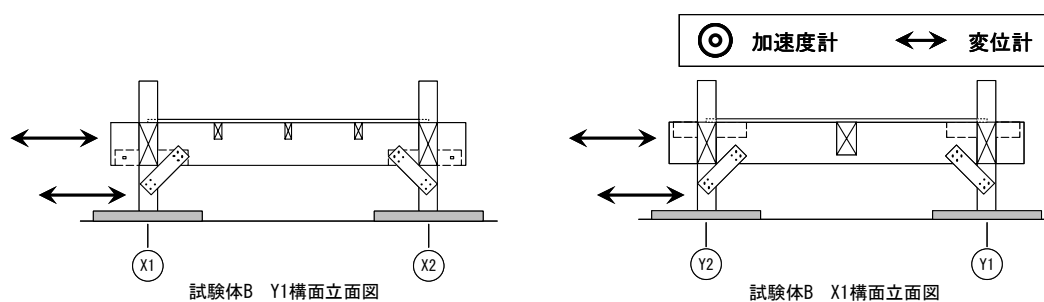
試験体 B 計測器配置図（伏せ図は試験体 A 胴差しレベルと共通）
